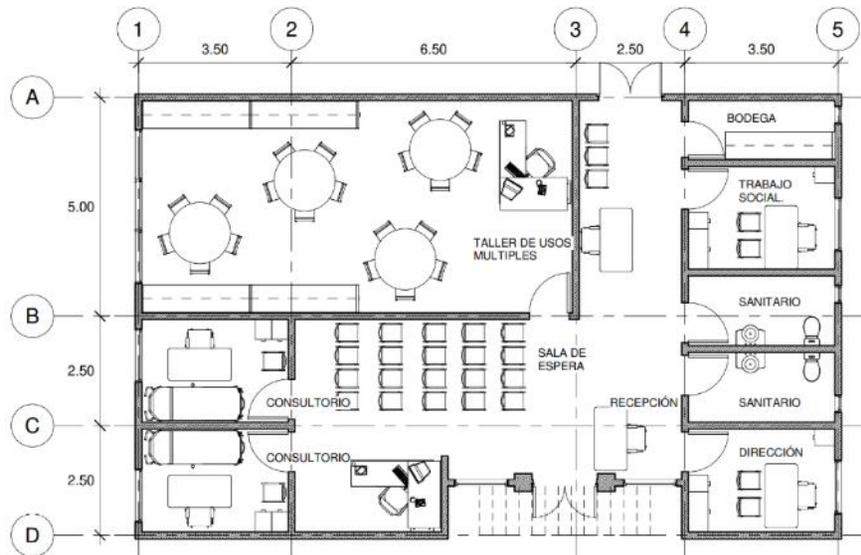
Planta arquitectónica del proyecto. Elaboración propia.
